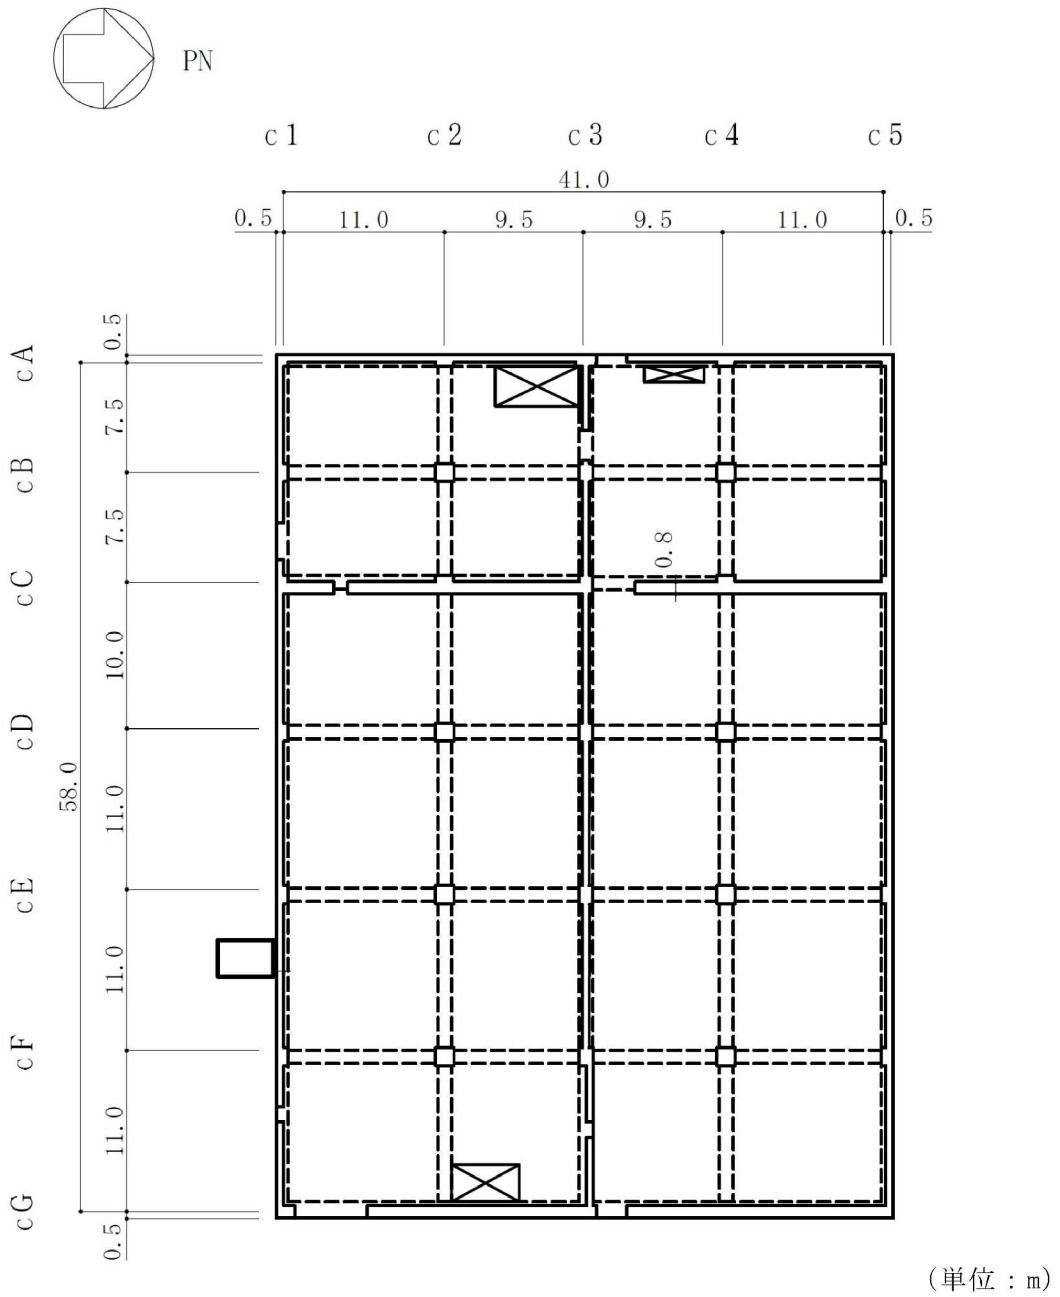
コントロール建屋の概略平面図 (1F, T.M.S.L. 12.3m) (3/5)
